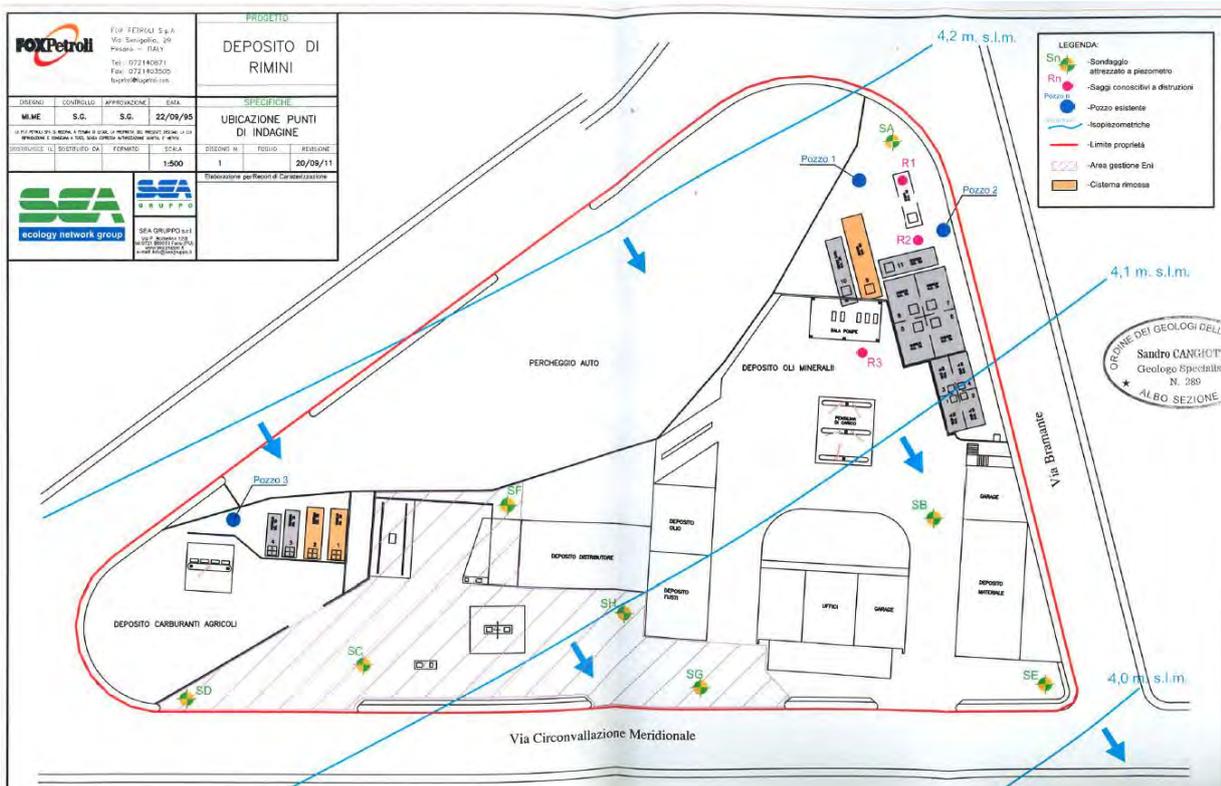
Planimetria con localizzazione dei punti di indagine (caratterizzazione 2011)
